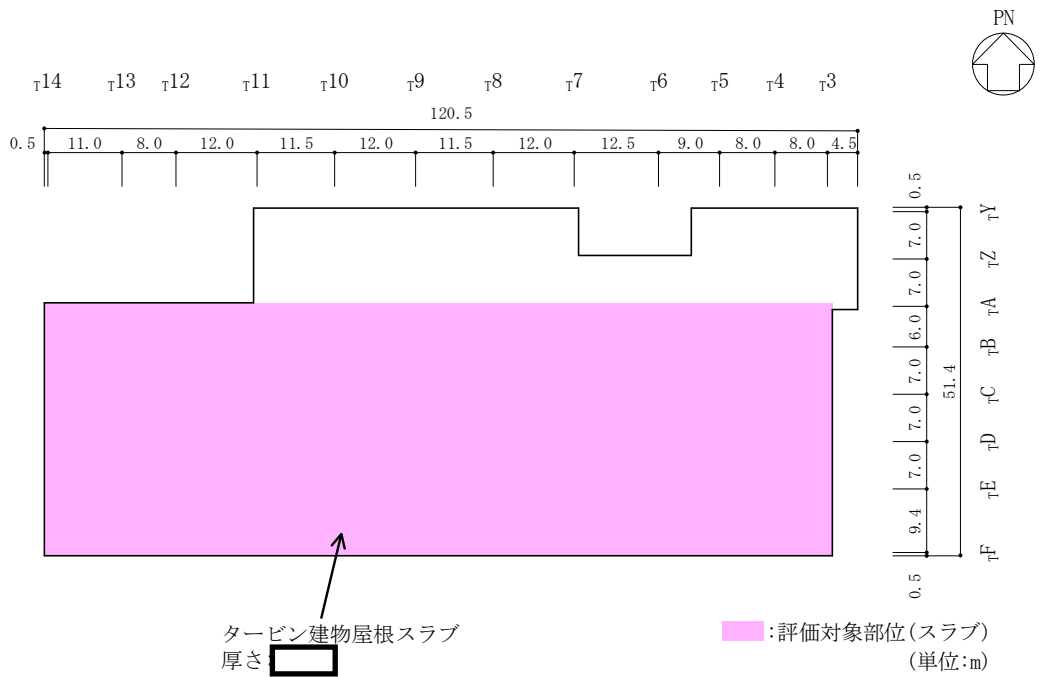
(2) タービン建物の概略平面図 (EL 41.6m)
